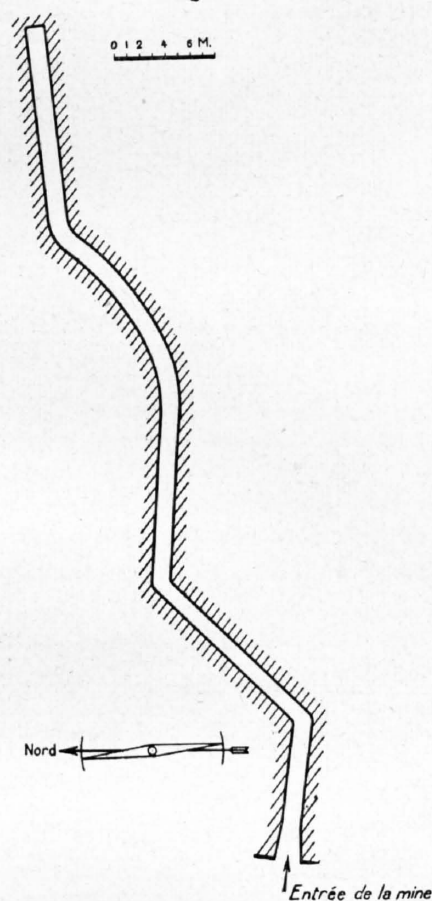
Mine de Barma, plan de la galerie Nord.
